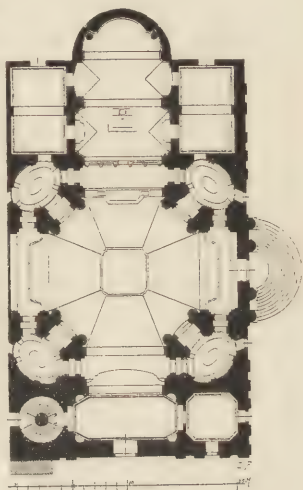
St. Nikolauskirche (Altstadt) zu Prag. Grundriss.
